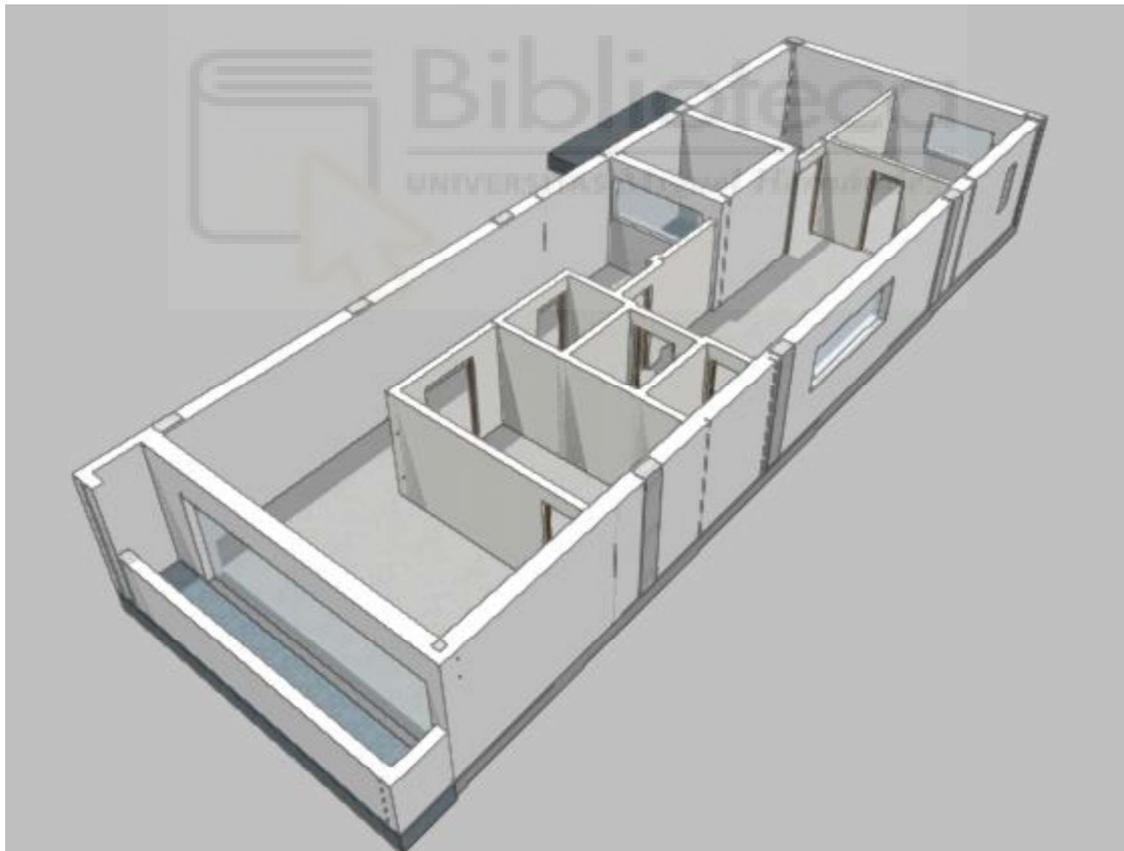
Distribución Planta Primera. Vista: En 3D. IFC Builder
